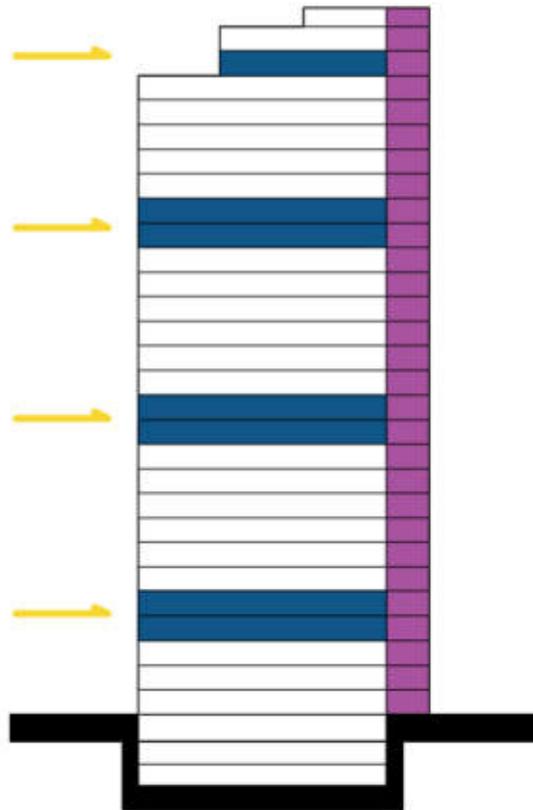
Corte esquemático, calidad espacial, Fuente: Elaboración propia.
